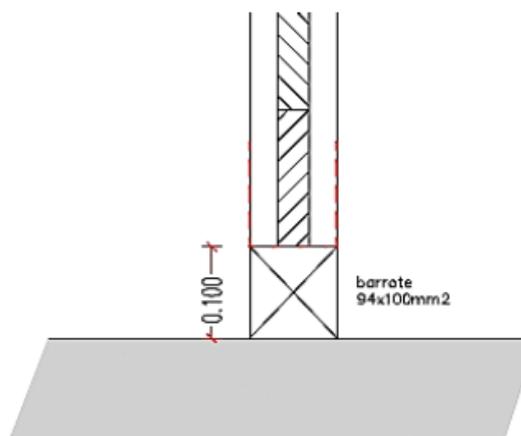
Pormenor construtivo ligação betão - CLT. (cedido pela Tisem)
